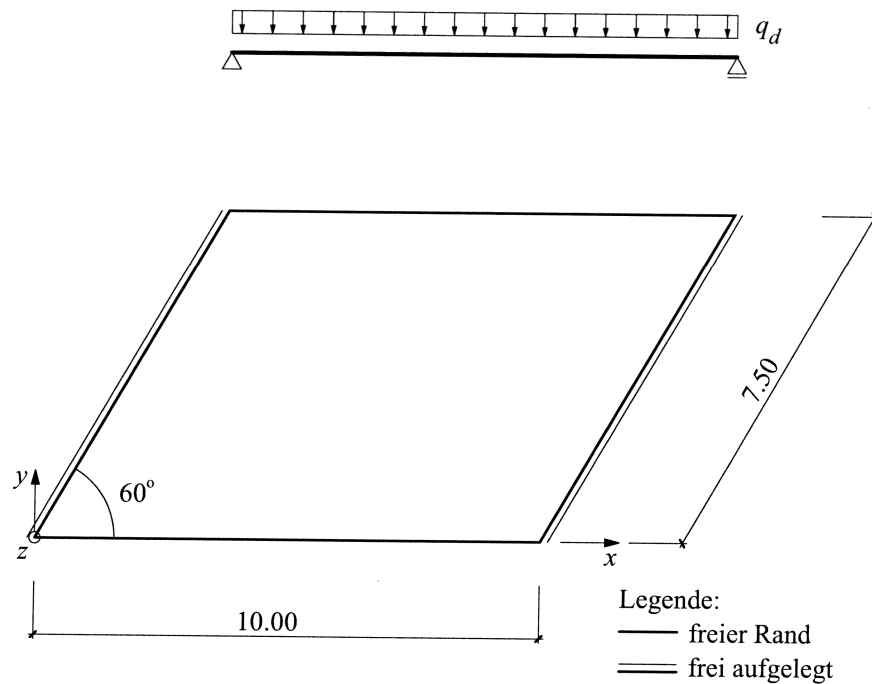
Schief gelagerte Platte, Abmessungen in m, Massstab 1:150.
